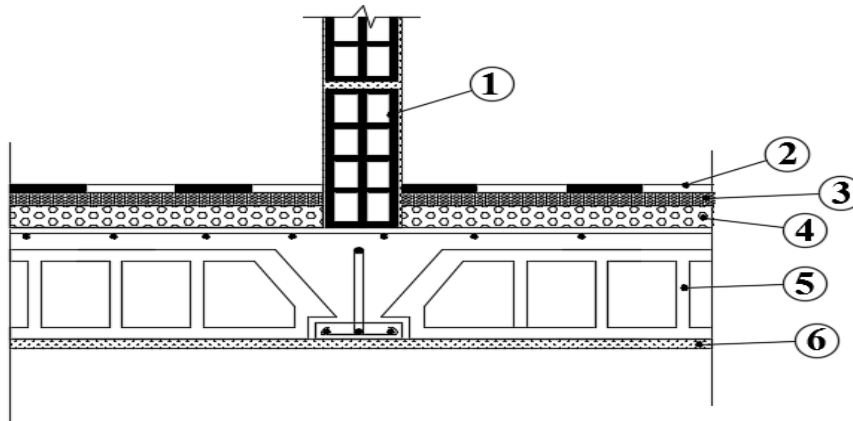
Coupe verticale d'un plancher d'étage courant.
